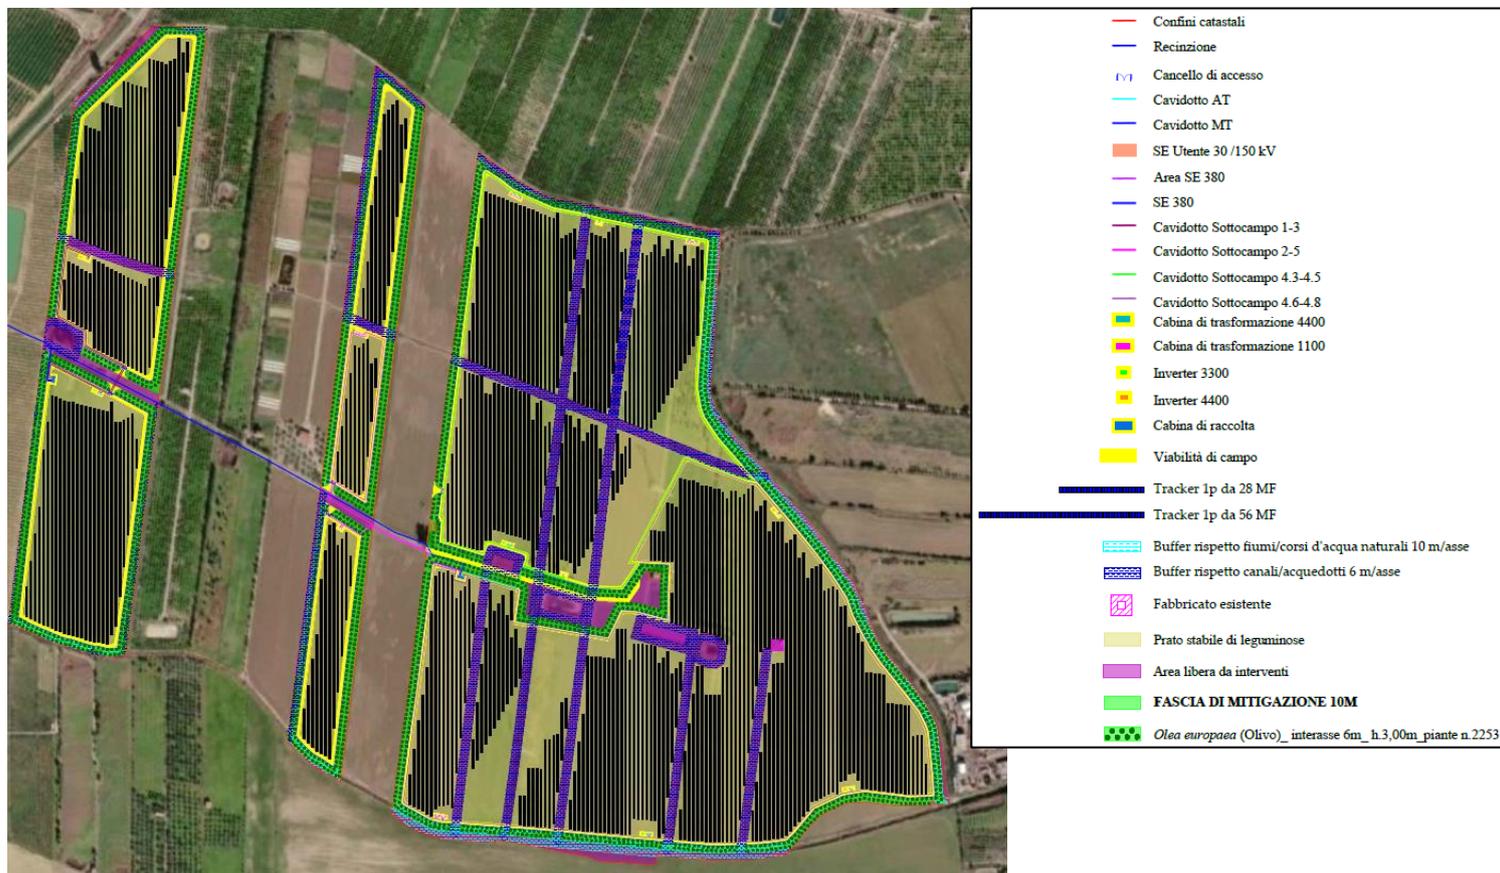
Planimetria delle opere di mitigazione e compensazione previste per il progetto.
